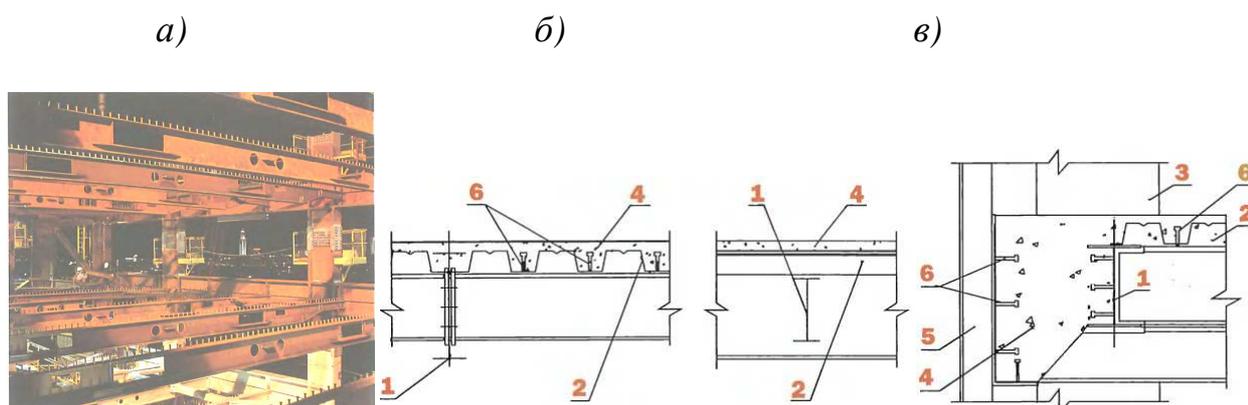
Общий вид и узлы опирания перекрытия из монолитного железобетона, уложенного по стальному профилированному настилу: *а* – общий вид каркаса со стальными балками, к которым приварены корытыши для крепления профнастила; *б* – главная балка, расположенная внутри здания; *в* – то же, расположенная в плоскости наружной стены; 1 – стальная балка; 2 – профилированный стальной настил; 3 – колонна; 4 – монолитный бетон плиты перекрытия; 5 – облицовка наружной стены; 6 – анкерные корытыши для крепления стального профилированного настила к стальной балке
